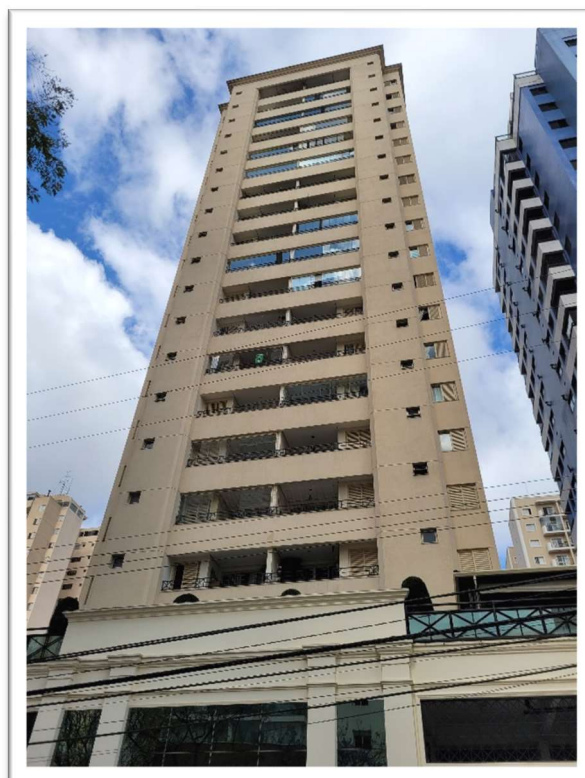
FACHADA FRONTAL DO PRÉDIO
